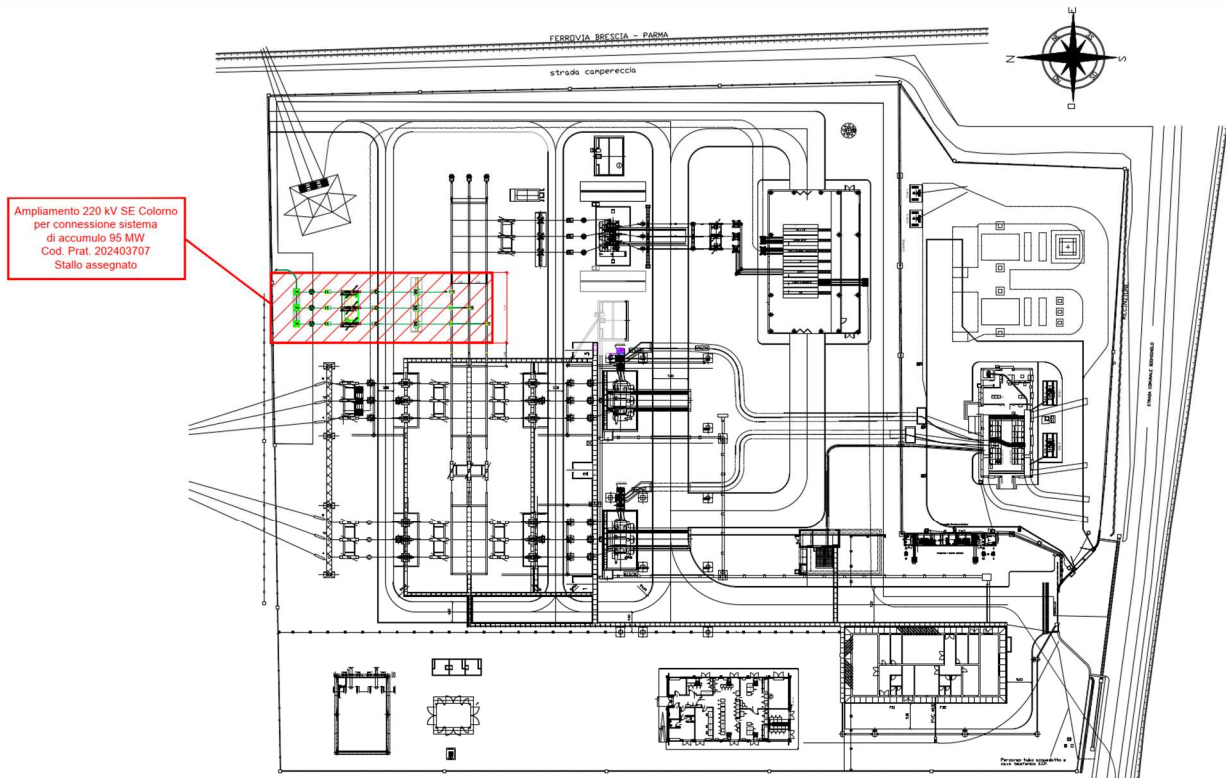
Planimetria elettromeccanica SE RTN "Colorno"
